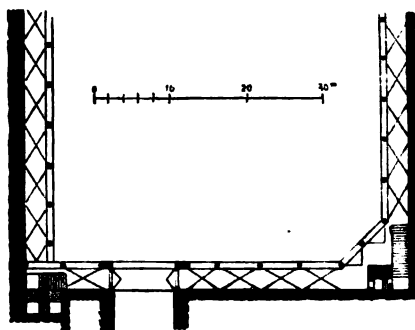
Grundriss des Schlosshofes zu Brieg.
